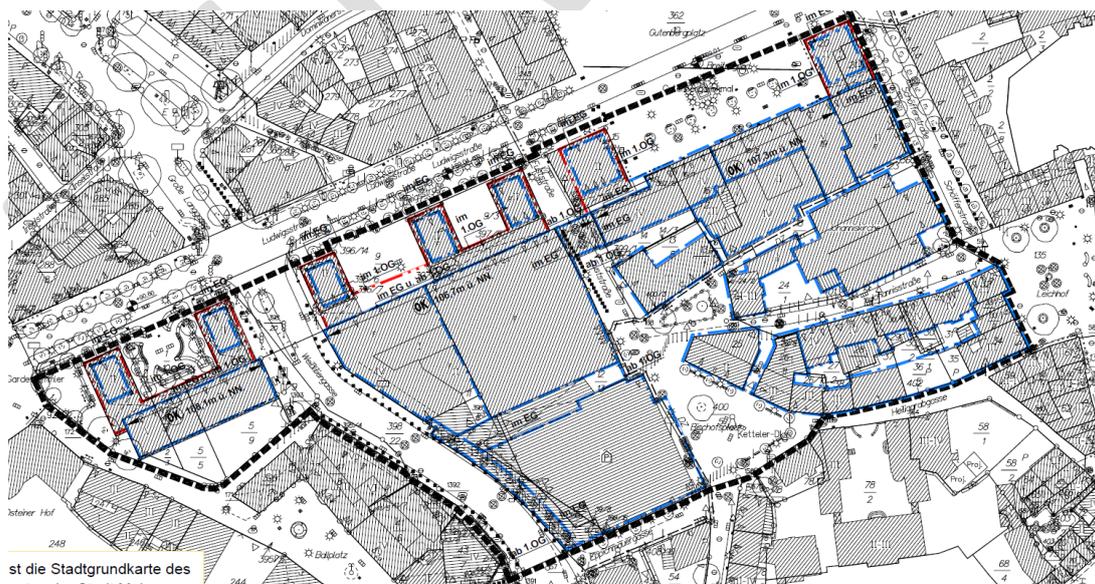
Planteil Bebauungsplan A (233/1. Ä)
